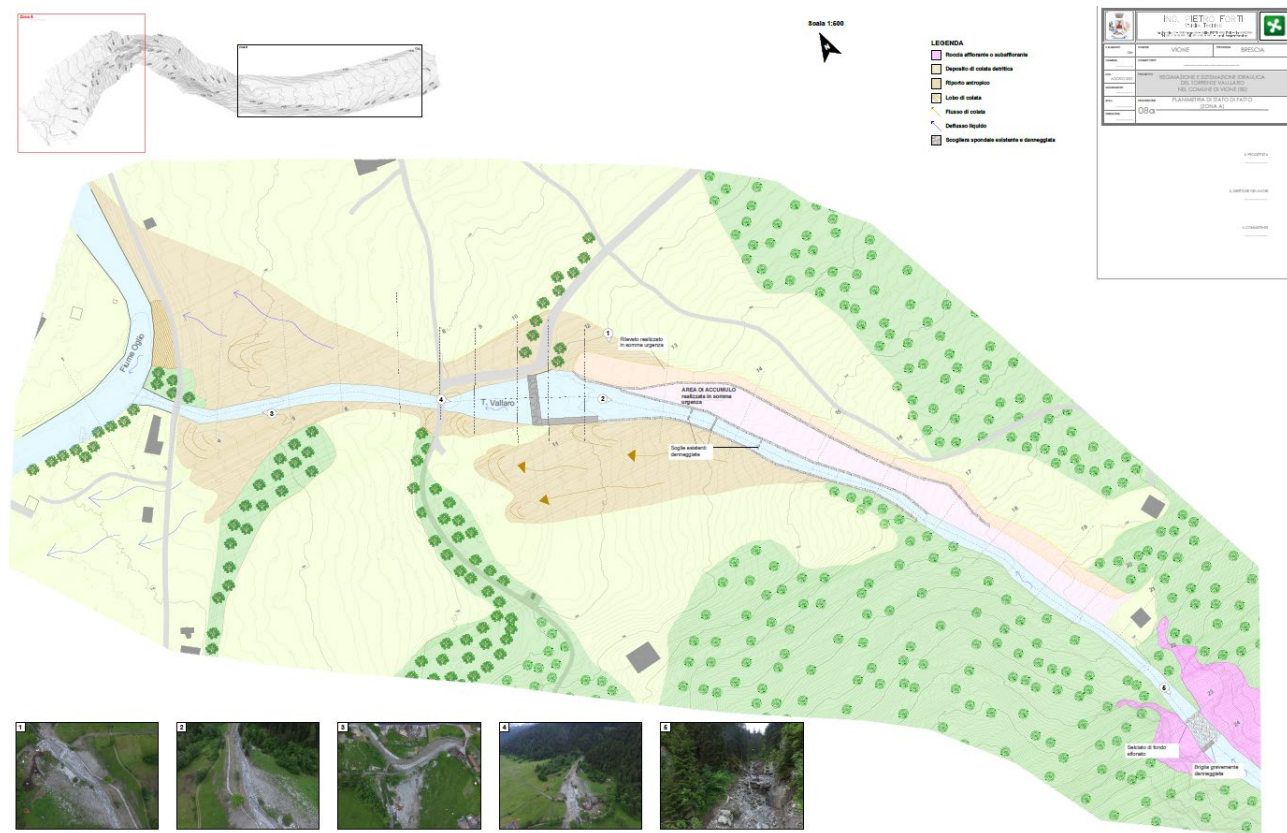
Estratto tavola 8a - Planimetria stato di fatto
